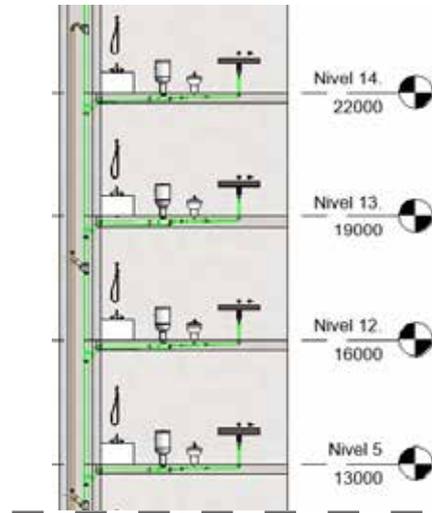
Ventilación secundaria hasta 15 plantas
